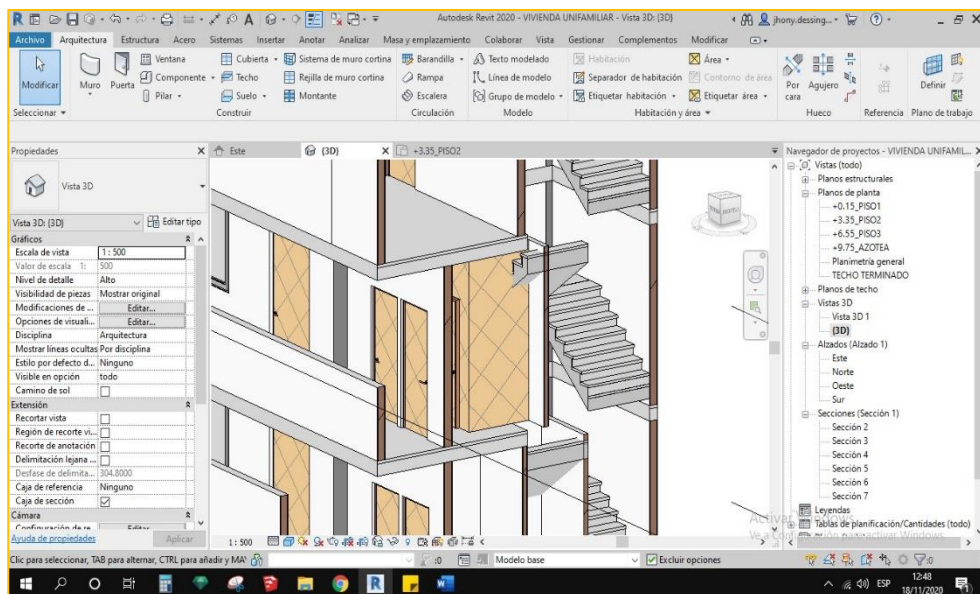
Vista en sección de la interferencia de muro en baño del segundo nivel con el recorrido de la escalera.
